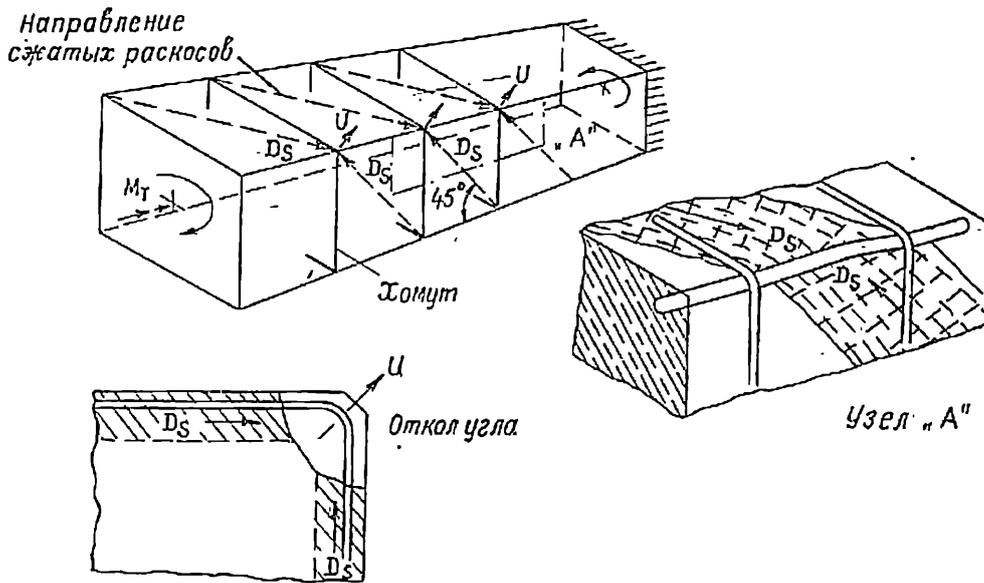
4. Откола угла под влиянием усилий сжатия бетонных раскосов можно избежать путем установки хомутов с частым шагом
